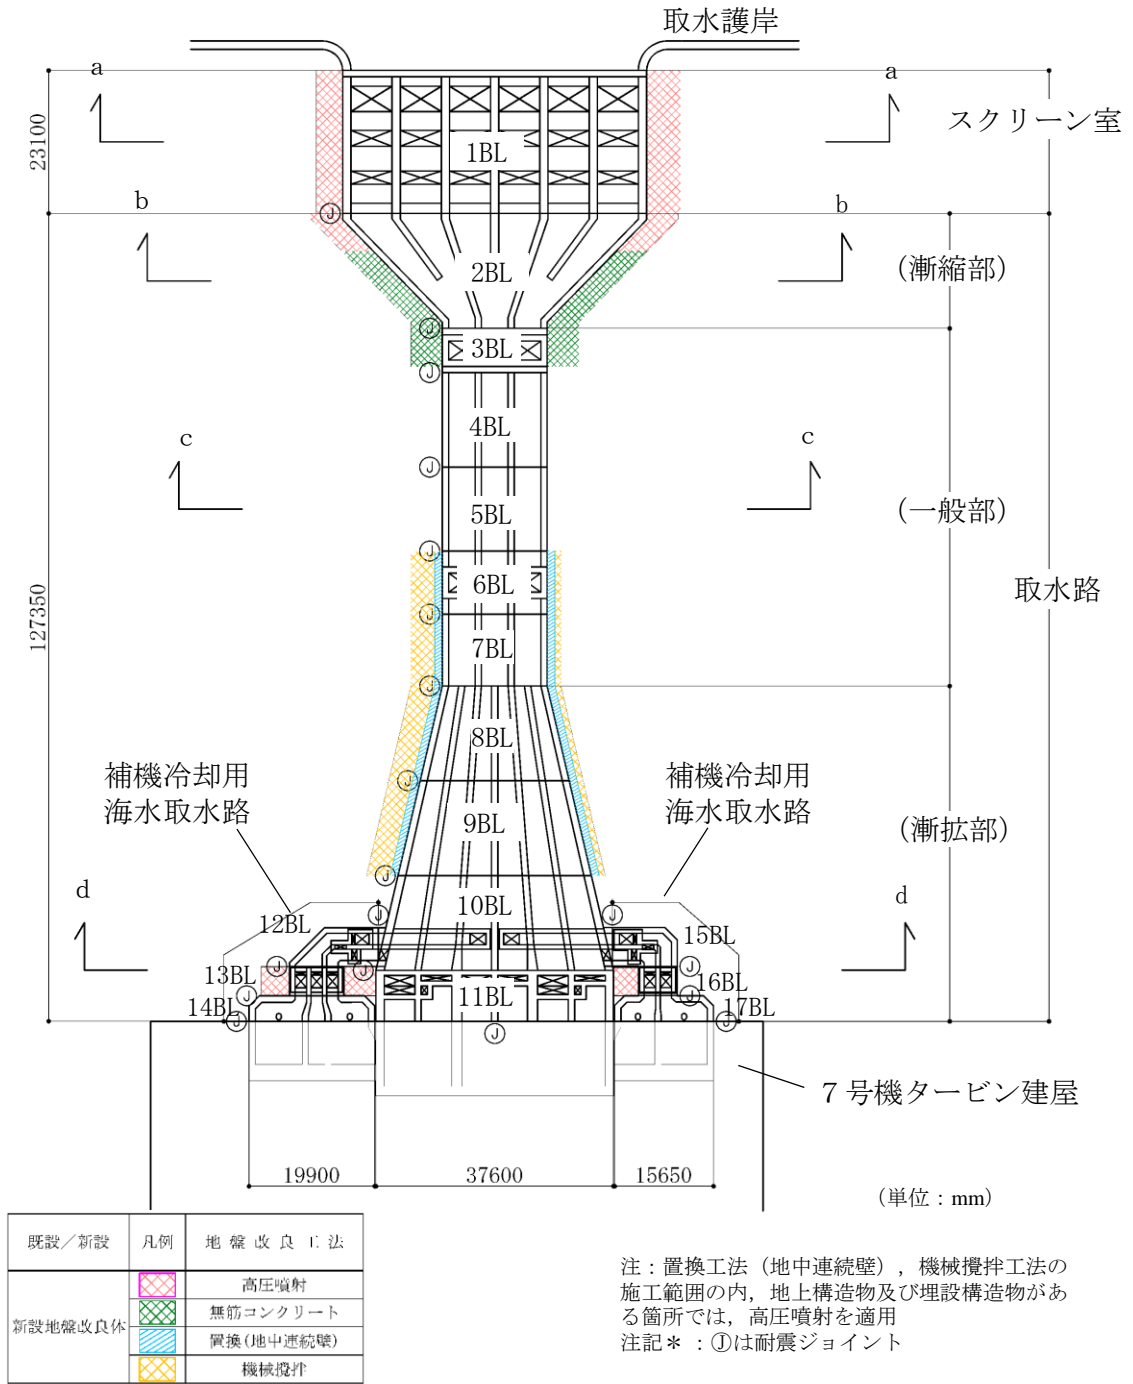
スクリーン室，取水路及び補機冷却用海水取水路の平面図
